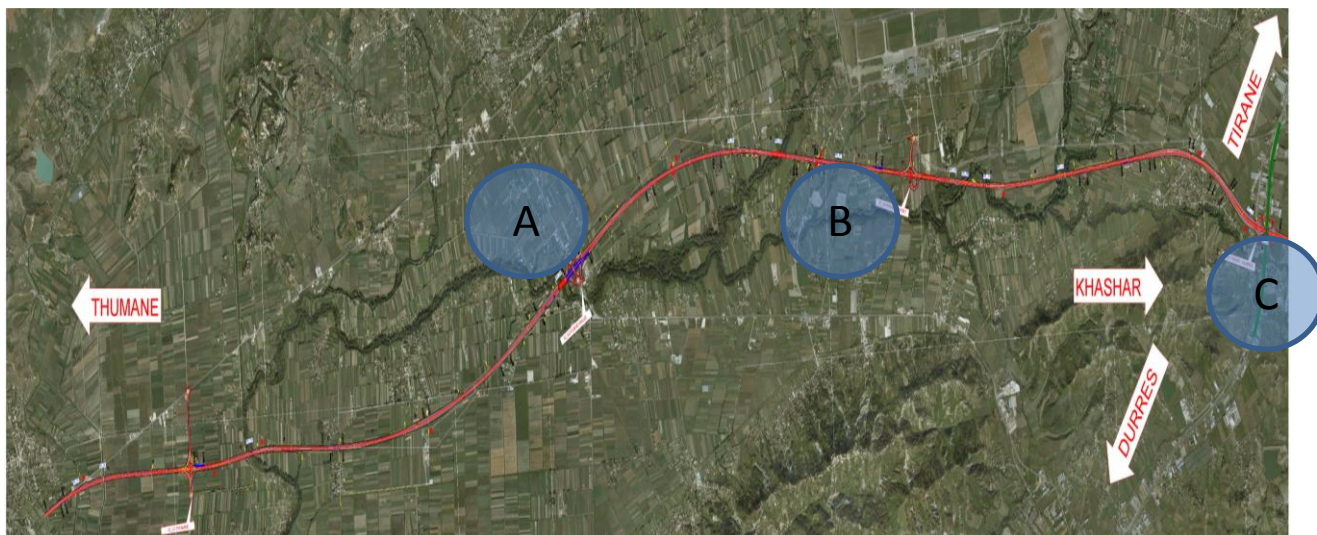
Planimetria perfundimtare e gjurmes se autostrades
